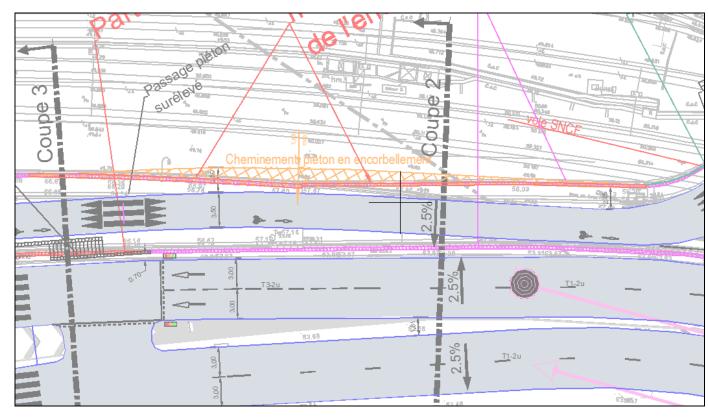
Vue en plan au droit de la rue Léonard de Vinci et du trottoir en encorbellement
